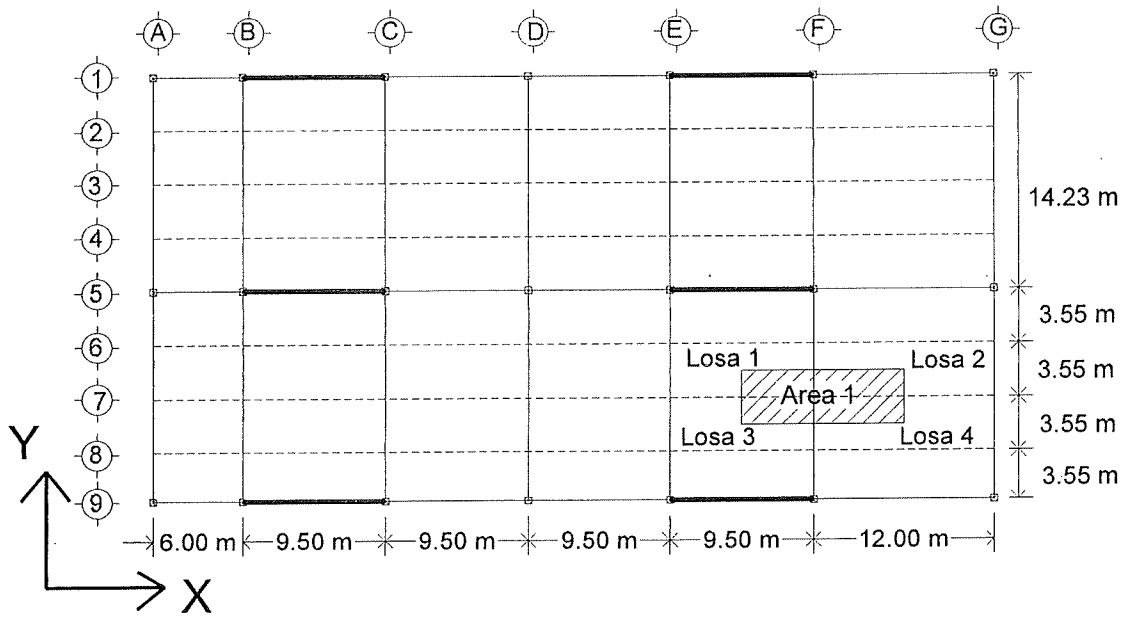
Área tributaria para calcular la carga P de la viga primaria.
